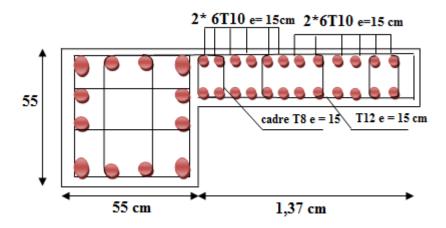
Détail de Ferraillage du Trumeau (T3) (T3'), coupe horizontale.
